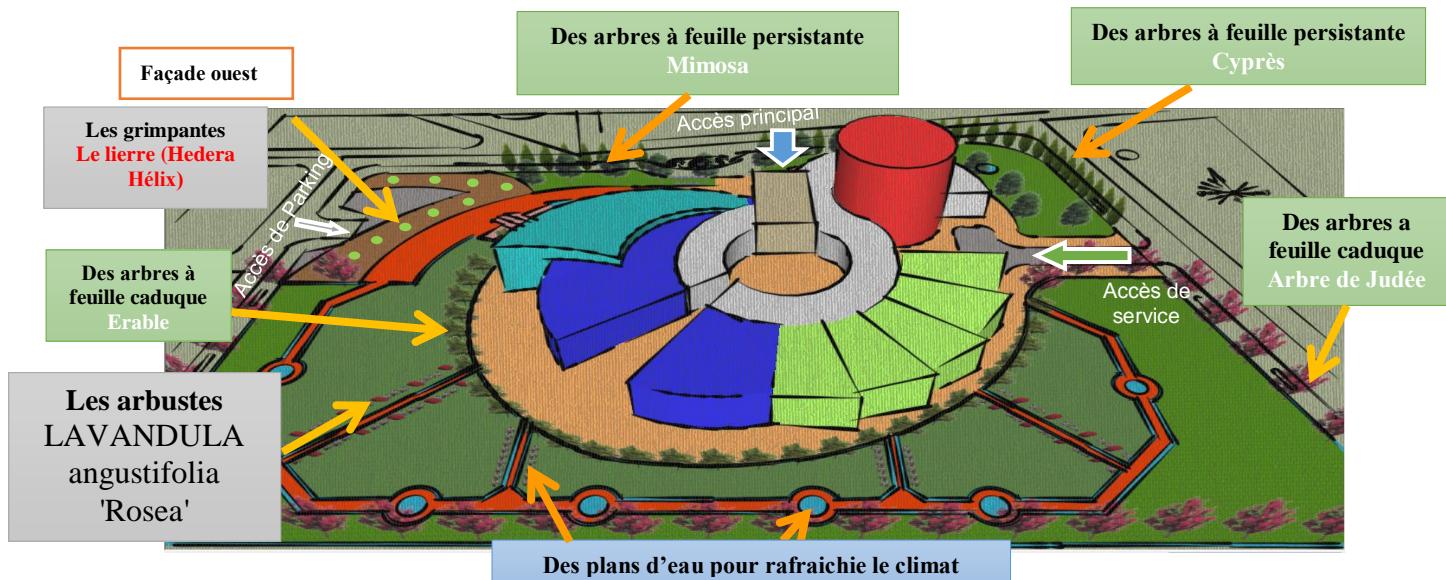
La végétation et les plans d'eau. Source : Auteur
